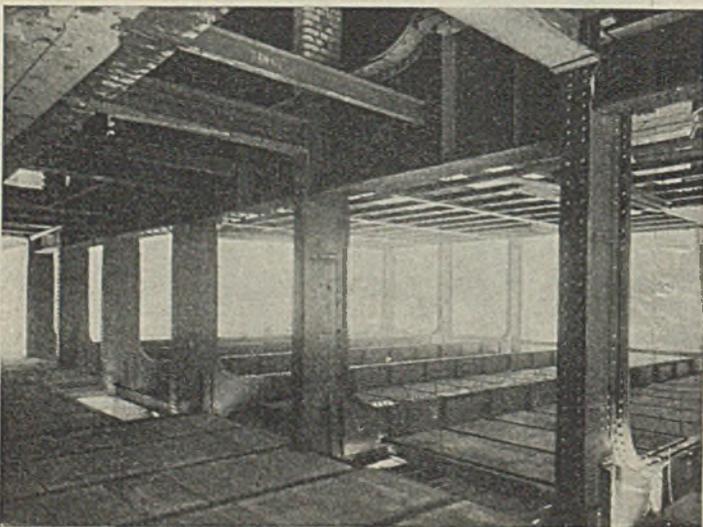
Konstruktion über dem 3. Obergeschoß. Ausmauerung des Hofflügels.
